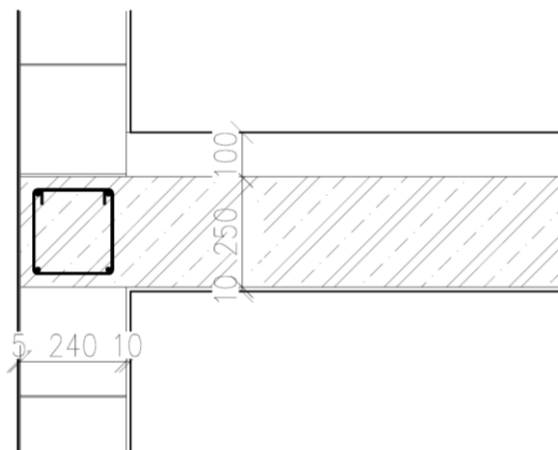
Schéma uložení stropní konstrukce na obvodovou zděnou stěnu 440 mm – varianta A
